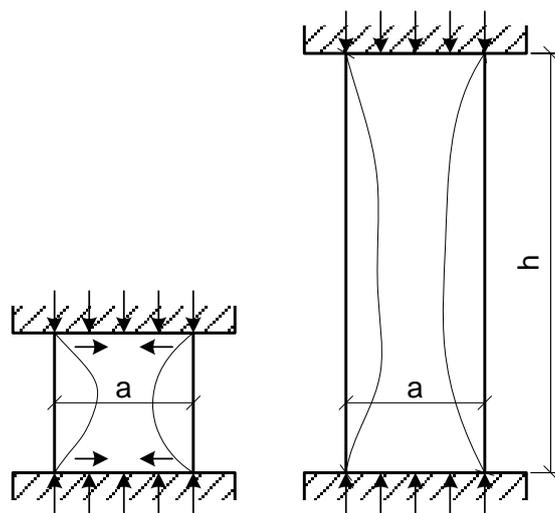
Випробування бетонного куба та бетонної призми на стиск
